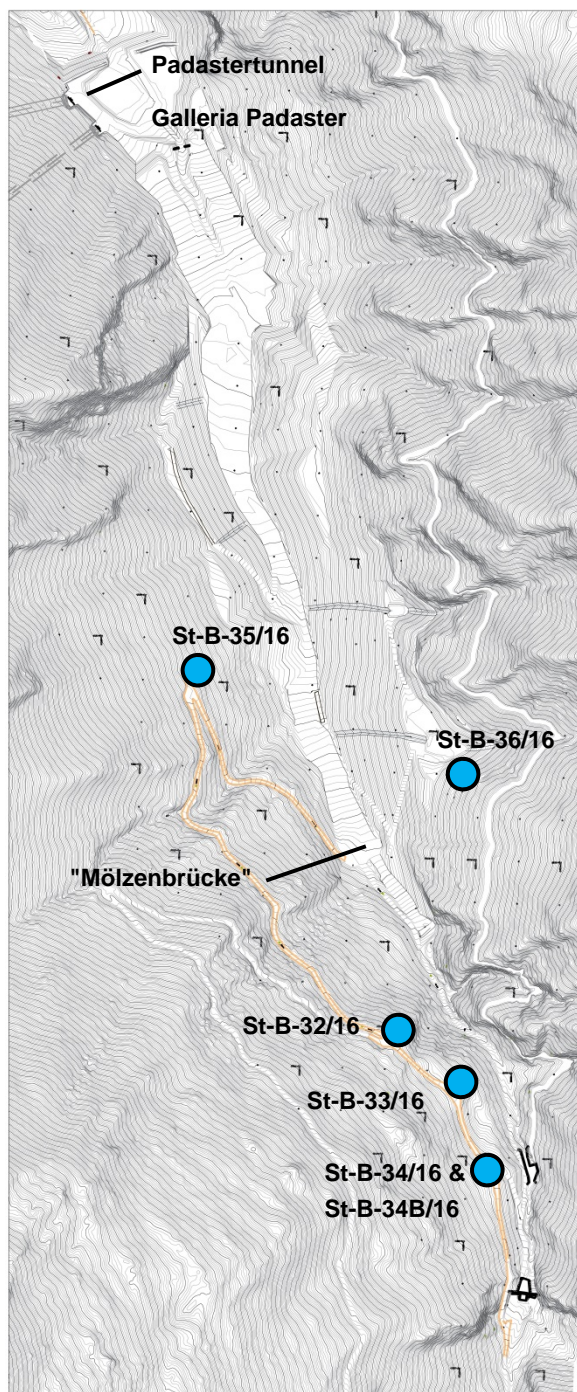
Lageplan mit Lage der Bohrpunkte im Bereich Padastertal
